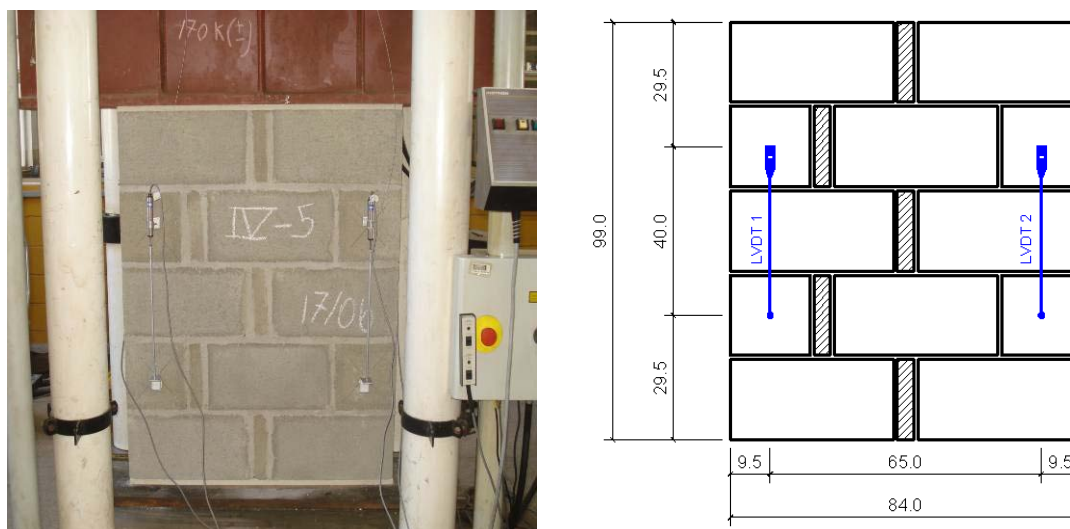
Ensaio à compressão das mini-paredes com rapaduras (medidas em cm)
